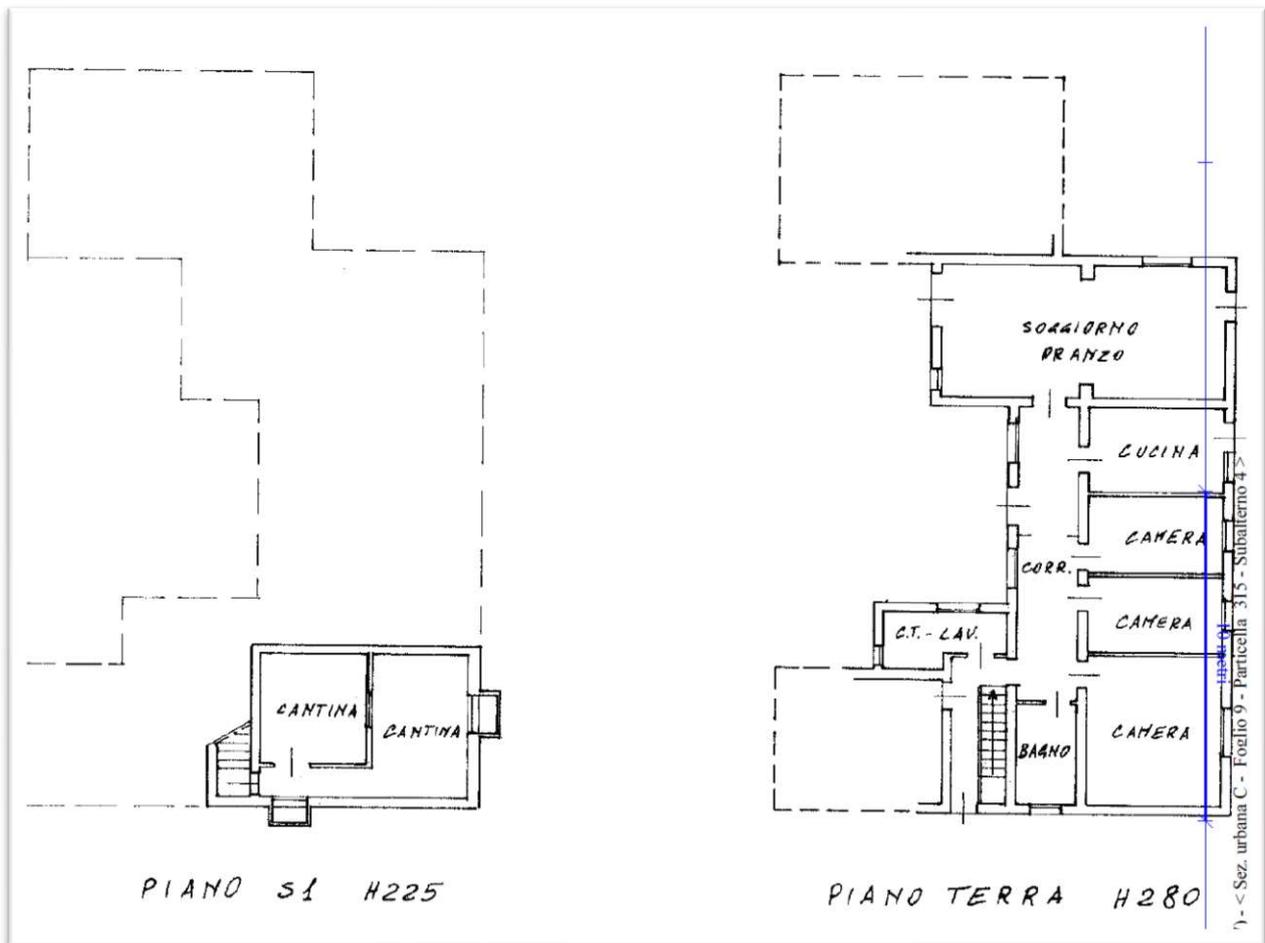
b: Estratto Planimetria catastale Mappale 315, Sub. 4
